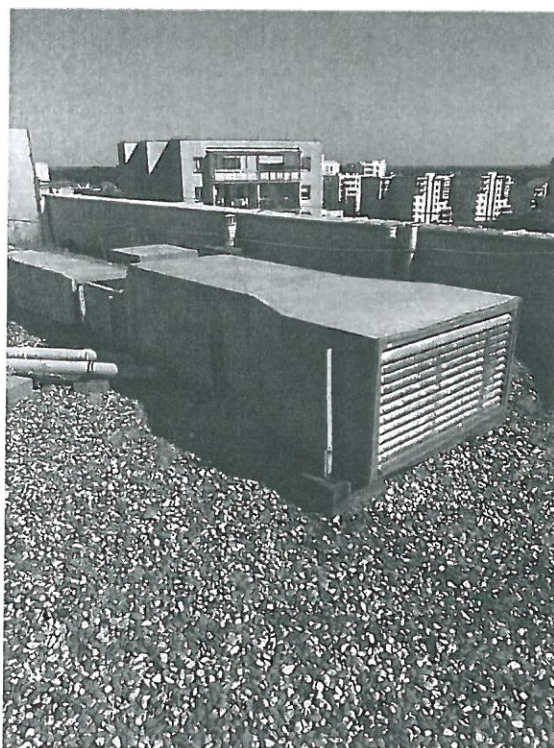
Kolejny widok na elewację oraz dach budynku mieszkalnego M1 przy al. KEN 36a.
